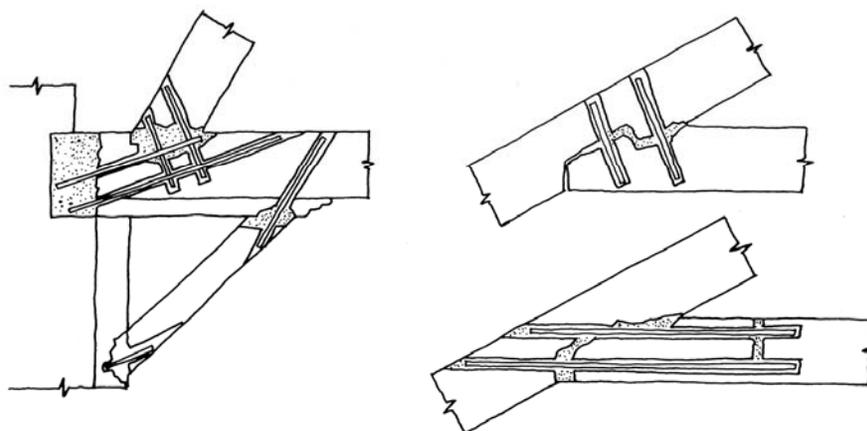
Consolidación de nudos de armaduras de cubierta.
